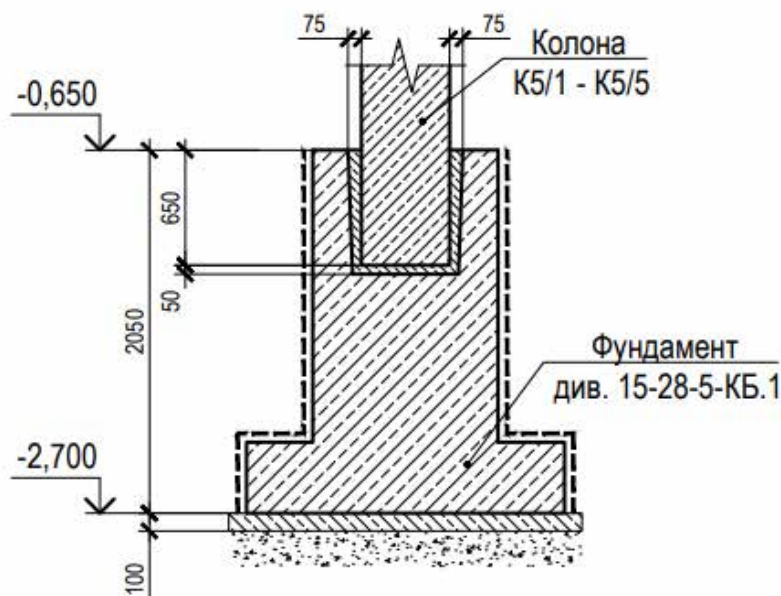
Монолітний залізобетонний фундамент стаканного типу
